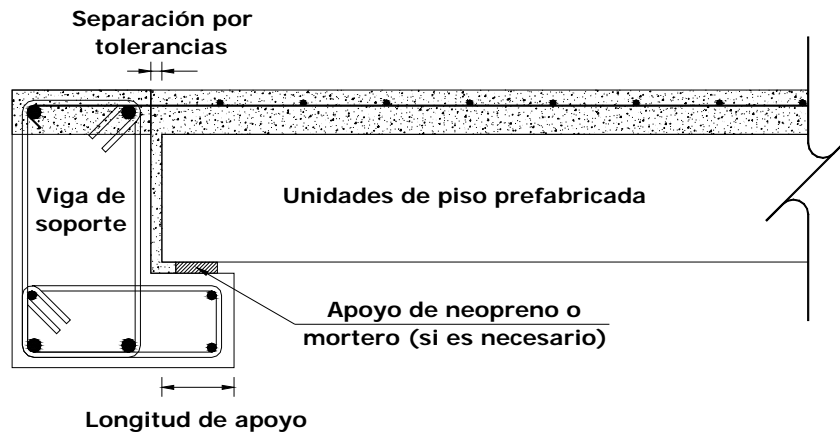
Apoyo típico de sistemas de piso prefabricados
